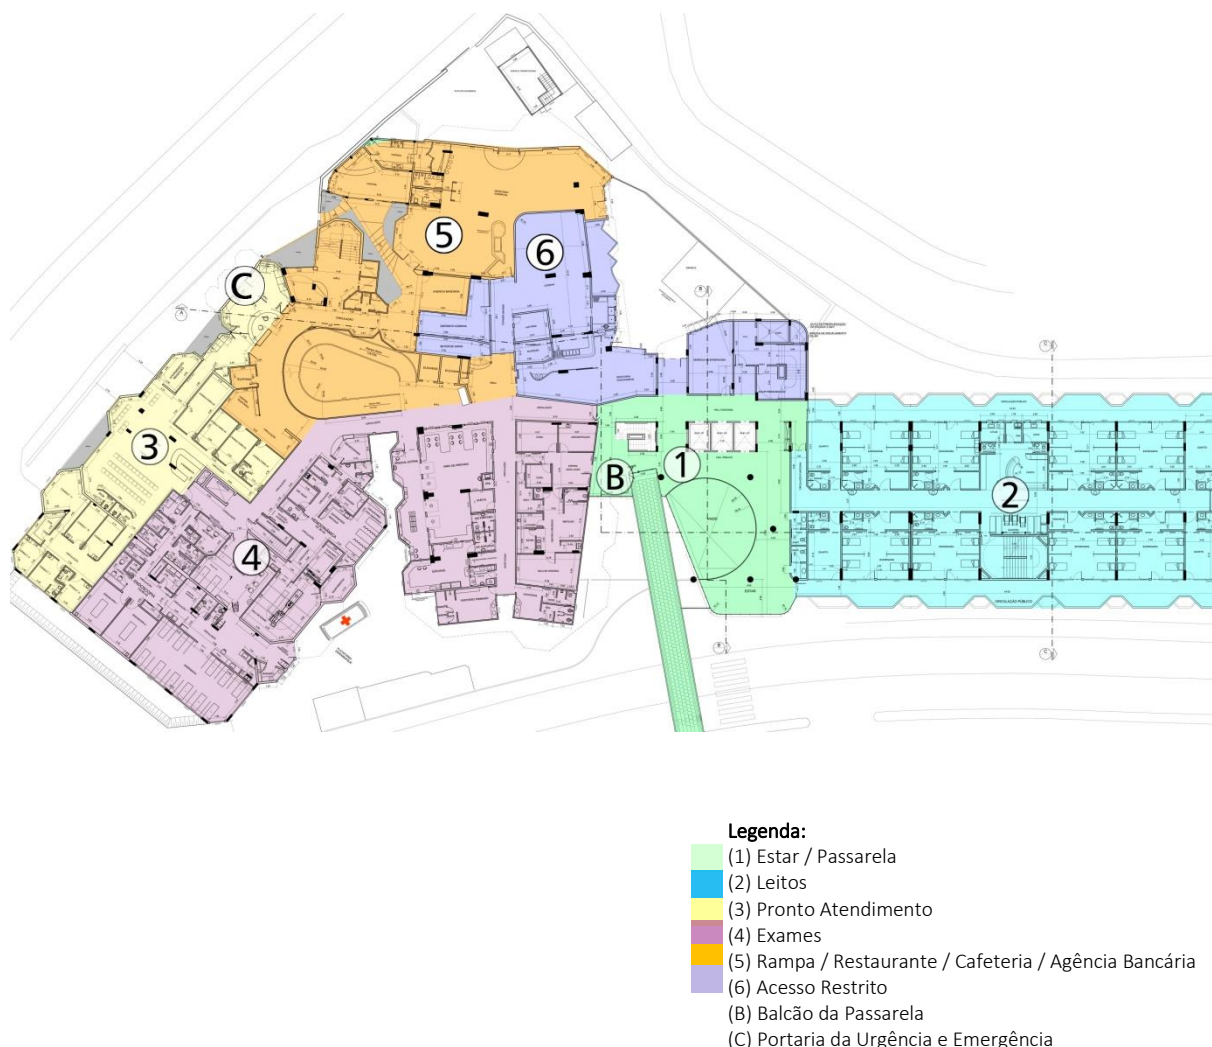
Planta setorizada do pavimento Térreo do Hospital B
